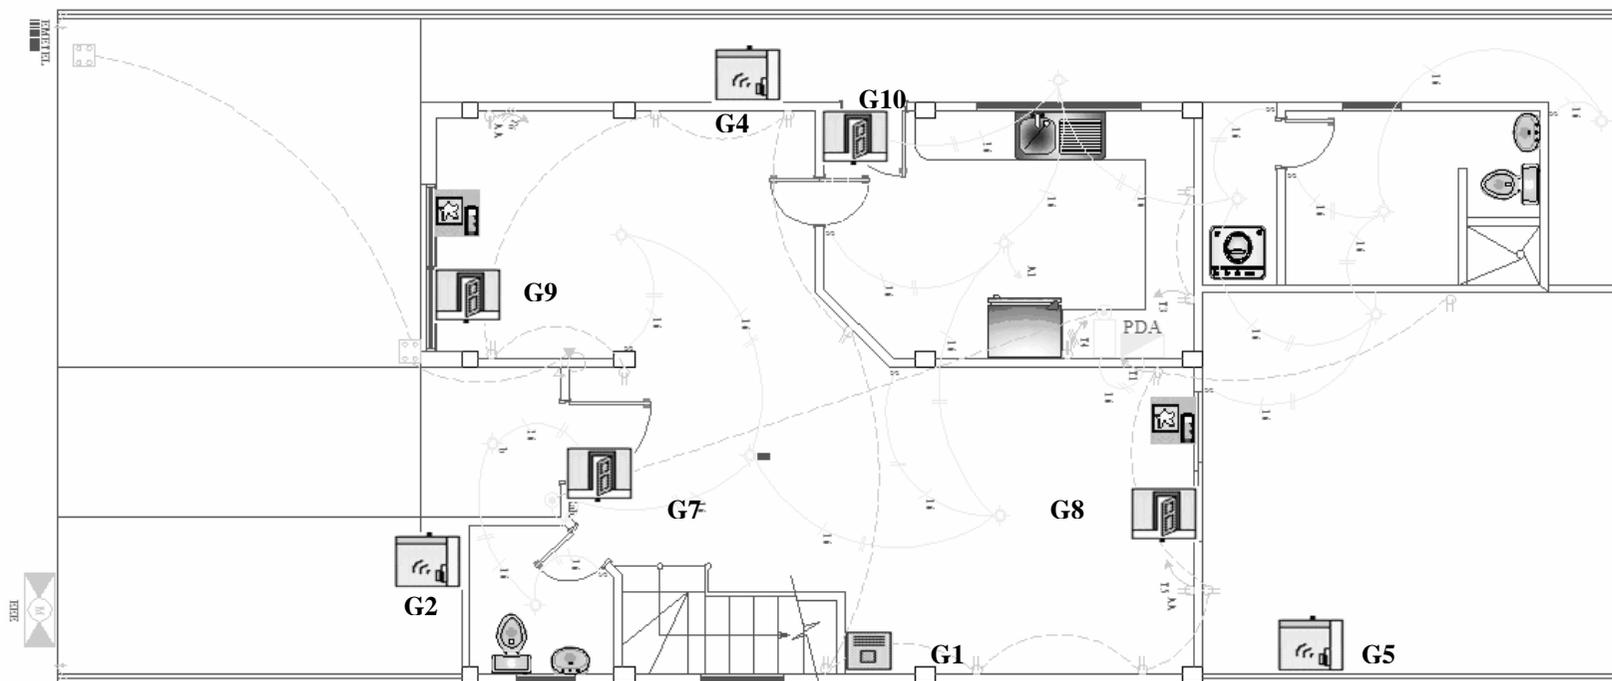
Sistema de Seguridad frente a intrusos, Planta Baja, Plano Eléctrico.
